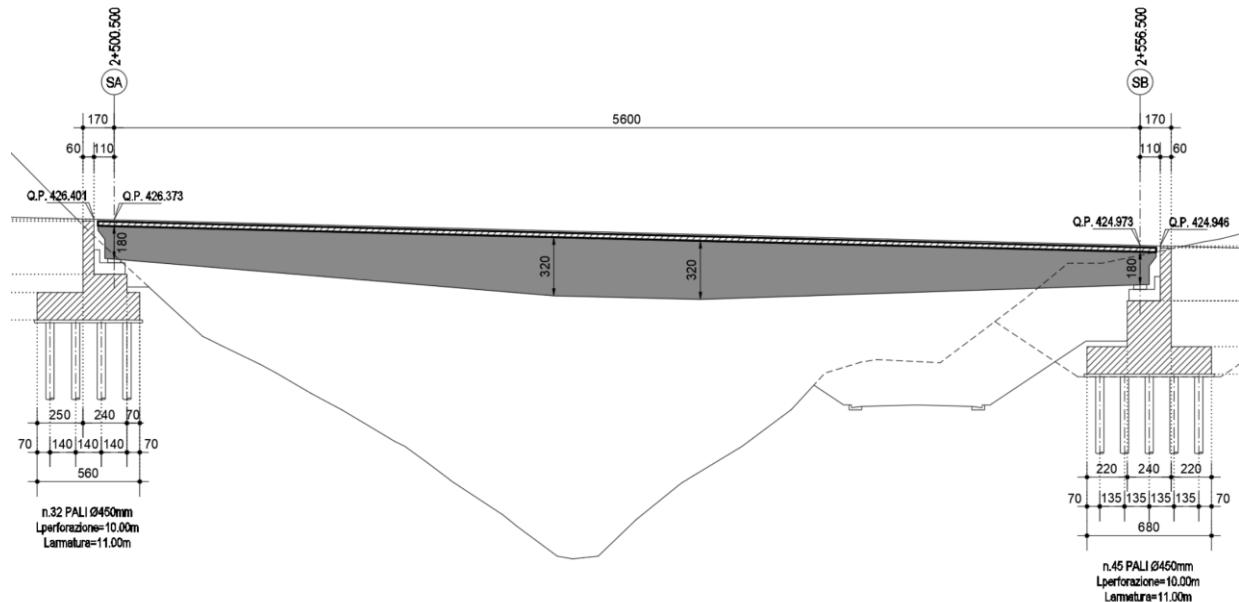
Sezione longitudinale lungo asse tracciamento
